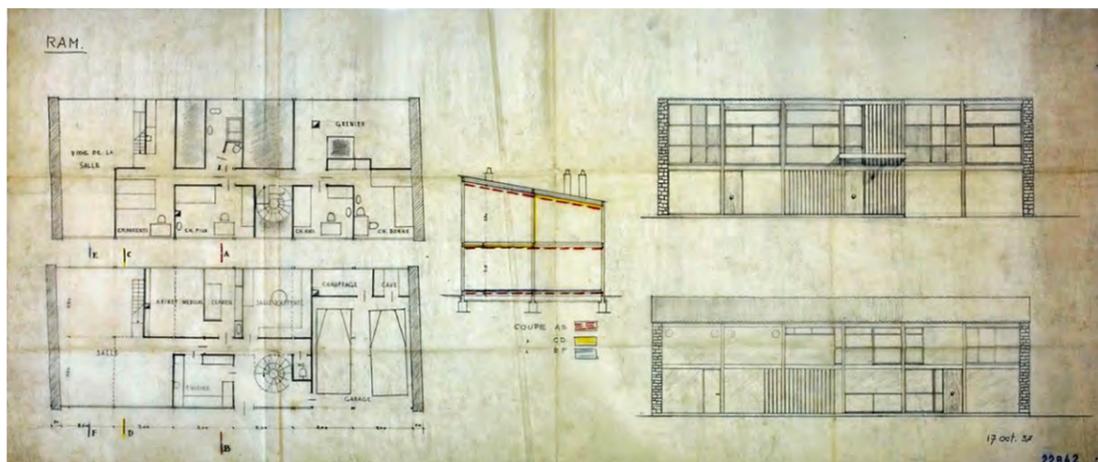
FLC 22842: *Projet A*. Plantas, alzados y sección.
